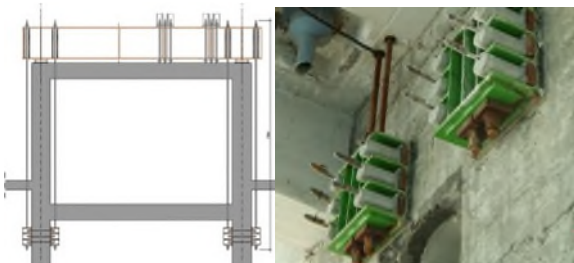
Anclaje de bancada para grúa a las vigas de cubierta
